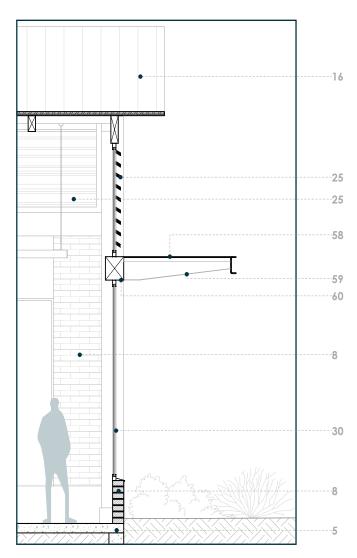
Escantillón S-06 Esc_1:50. Fuente: Autores, 2024
